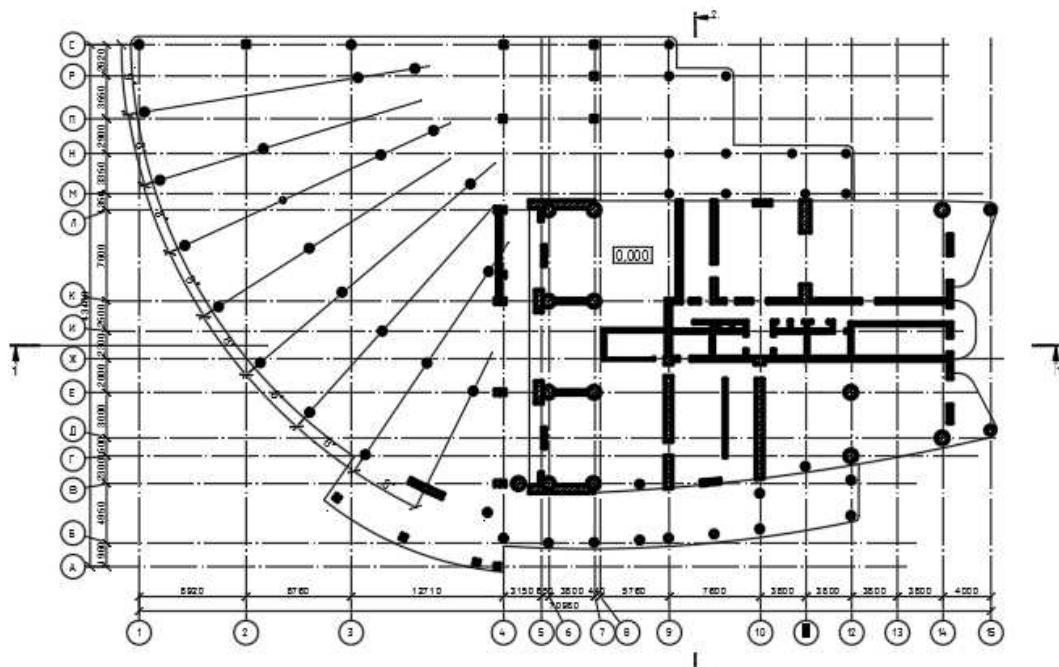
Расстановка несущих колонн и стен железобетонного монолитного здания на отметке 0.000
